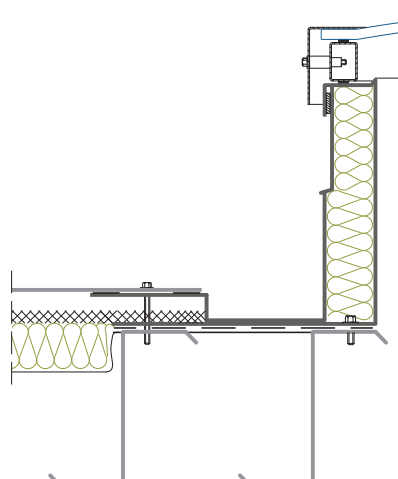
Przekrój podłużny przez klapę mcr PROLIGHT typ E z podstawą PR do dachów profilowanych wzdłuż spadku dachu
